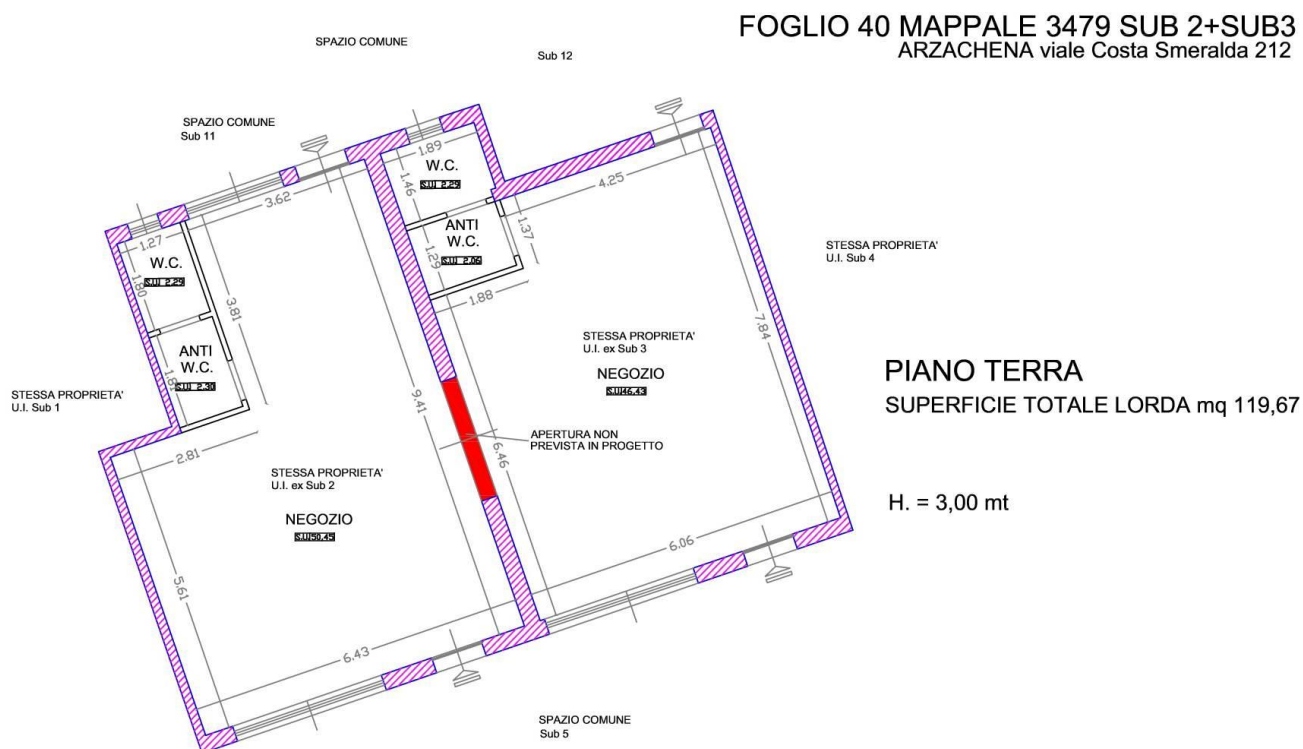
Pianta del locale commerciale dopo rilievo primo accesso
